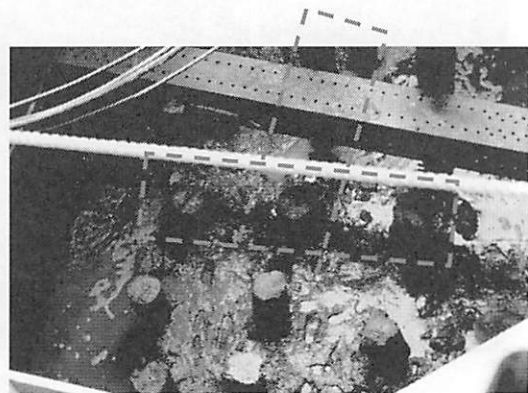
基礎杭(松杭)配置(1基3×9本)
